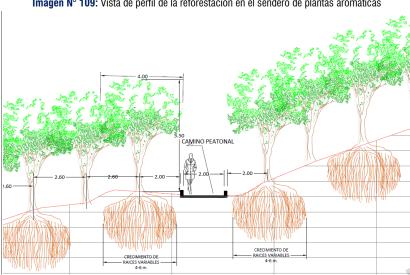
Vista de perfil de la reforestación en el sendero de plantas aromáticas
